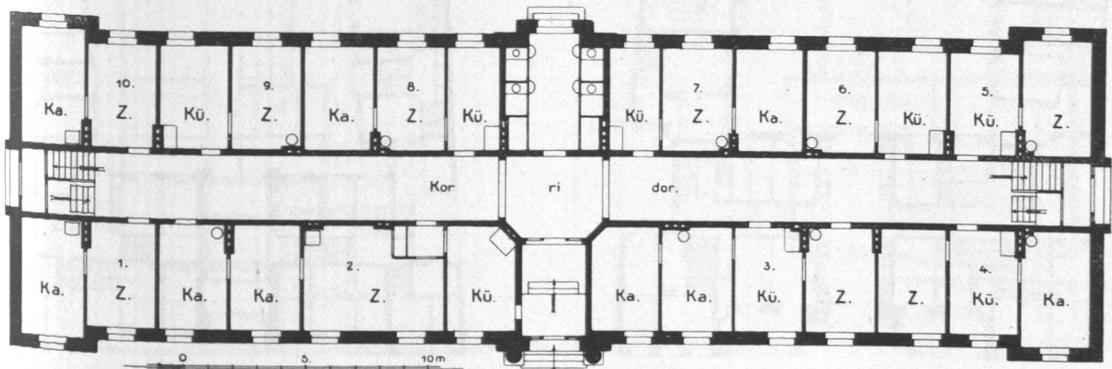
Martin-Brumm-Stift, Erdgeschoß, Grundriß.
